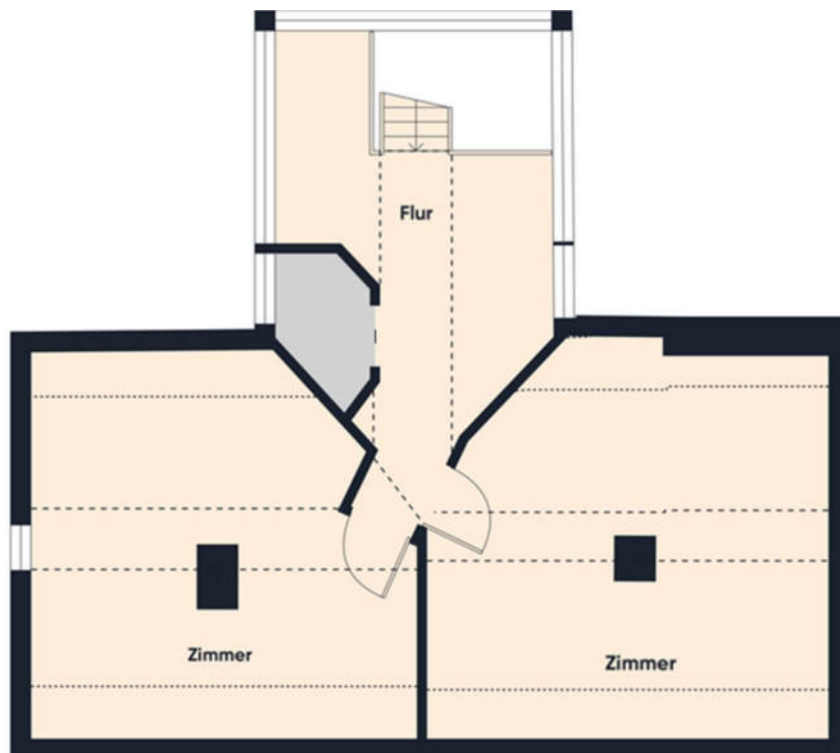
Grundriss Dachgeschoss (Aufmaß am Ortstermin)
